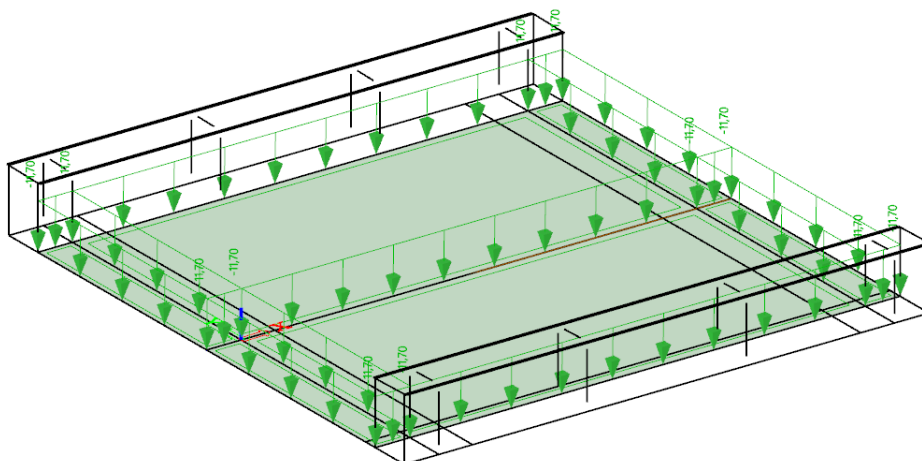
ZS3 - Zatížení betonovými pražci B91
